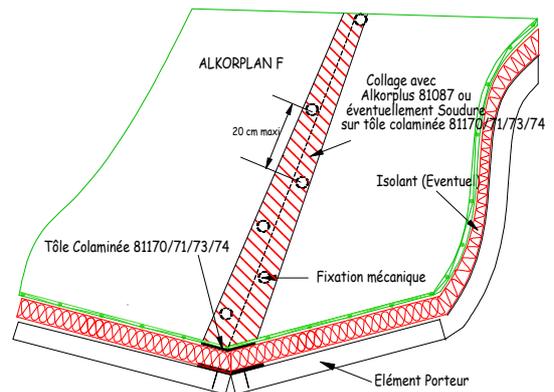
Etanchéité d'entrée d'eau pluviale
